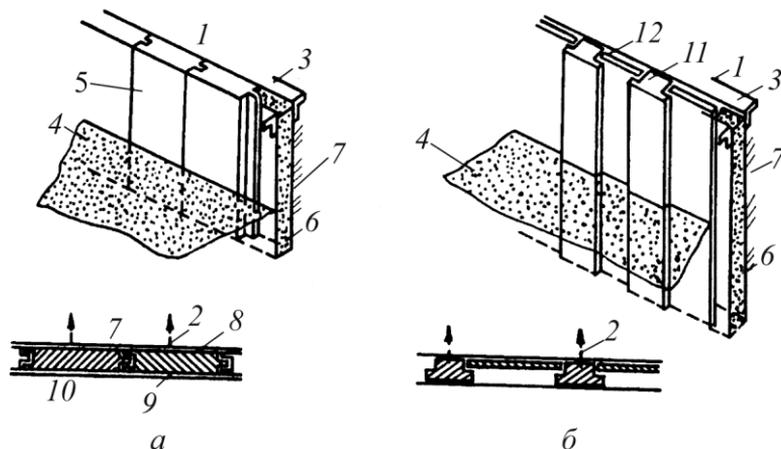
Стенки в грунте из сборных панелей: *а, б* – стенки из плит и балок и плит; *1* – поверхность грунта; *2* – место расположения анкера; *3* – воротник траншеи; *4* – дно котлована; *5* – стеновая панель; *6* – раствор; *7* – неразрабатываемый грунт; *8* – раствор; *9* – раствор, удаляемый при разработке котлована; *10* – грунт, удаляемый при разработке котлована; *11* – балка; *12* – плита
